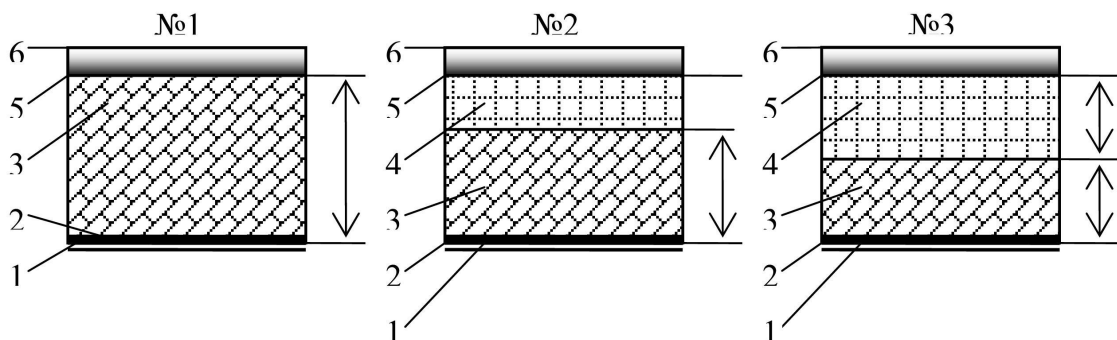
Схемы сталебетонных плит с утеплителем.
